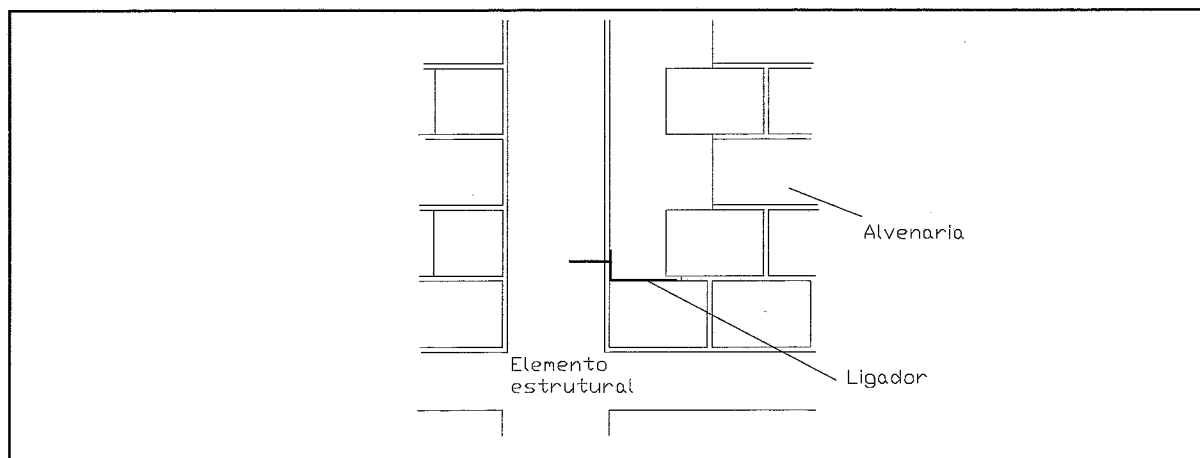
Pormenor de aplicação de ligadores em reabilitação
